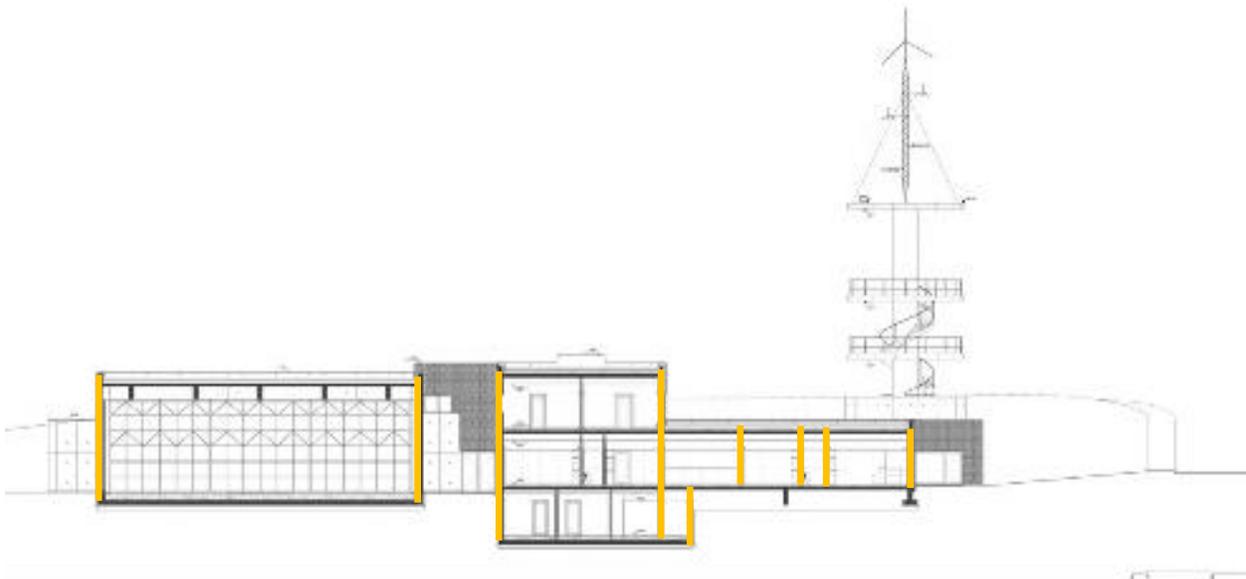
Análisis de Sistema constructivo. Fuente: elaboración propia a partir de imagen del proyecto.
